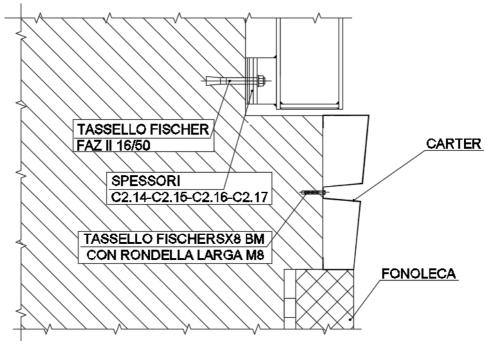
Dettaglio del collegamento inferiore HEA200 e HEA180 barriera lato ferrovia
